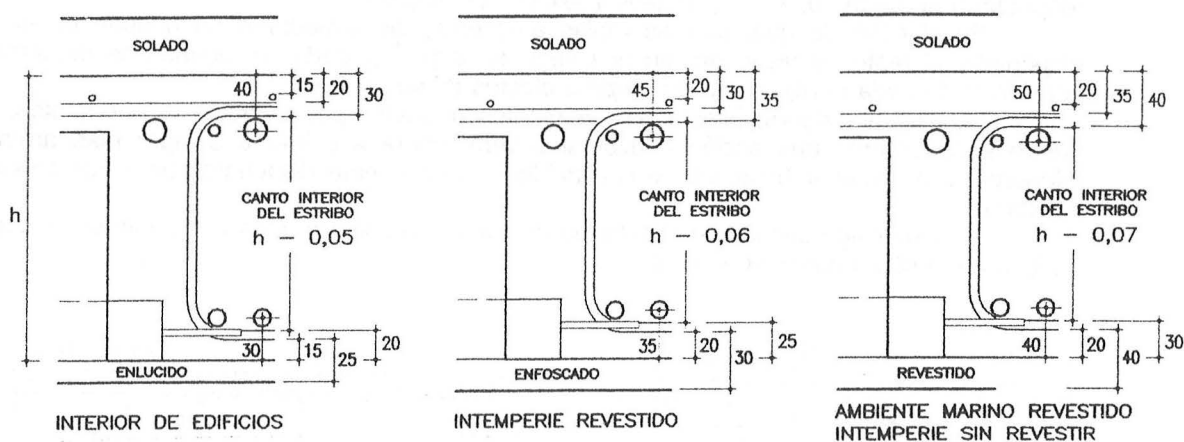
Recubrimientos tipo (en mm) y canto del estribo
